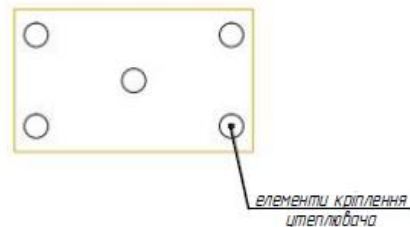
Схема укладання та кріплення плит утеплювача в один шар на кут будівлі
